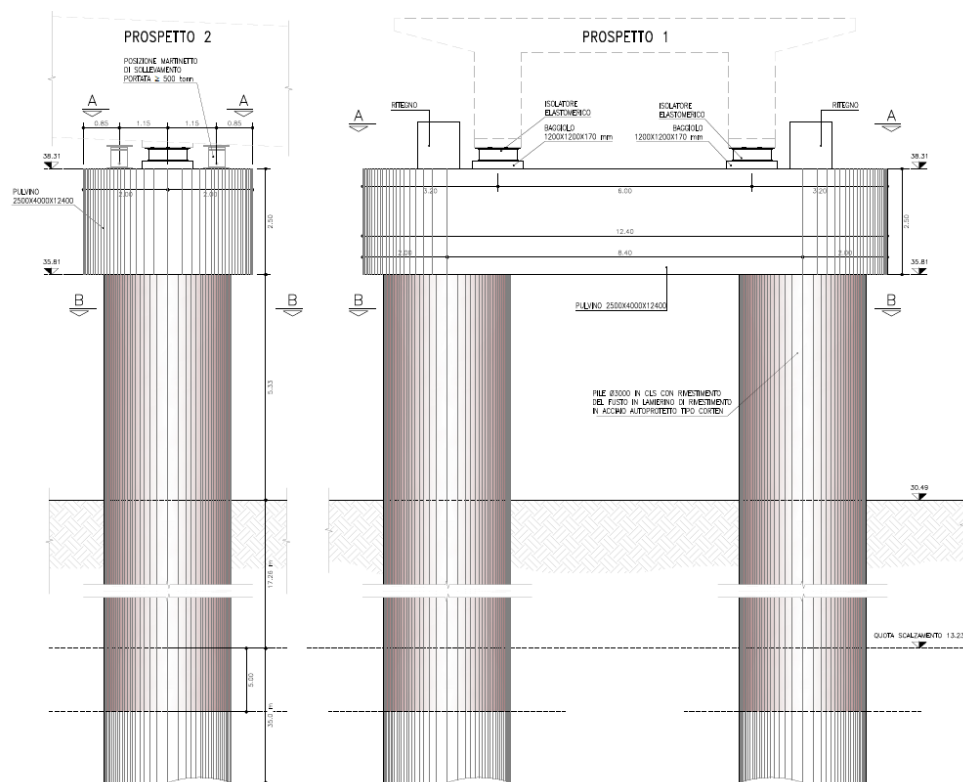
5: Sezione trasversale tipo su pila (2 - 6)
